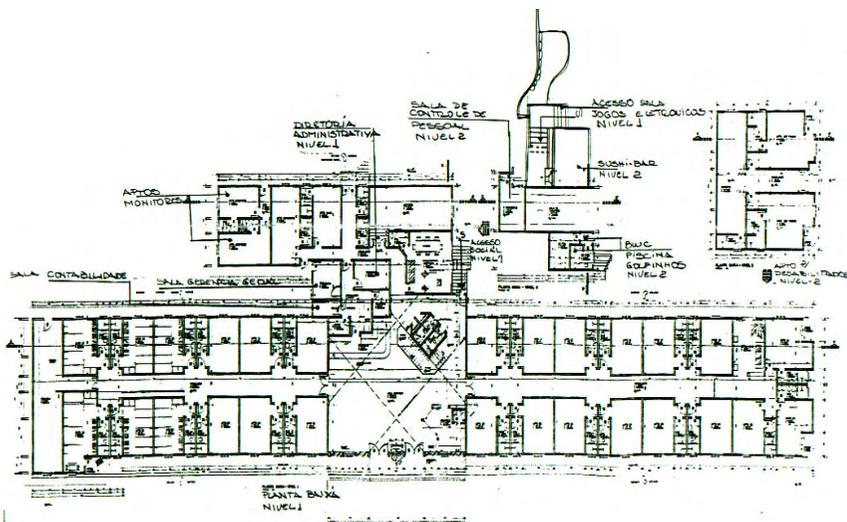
Planta do Bloco A. Fonte: Arquivo do Hotel Hidrotermal.
